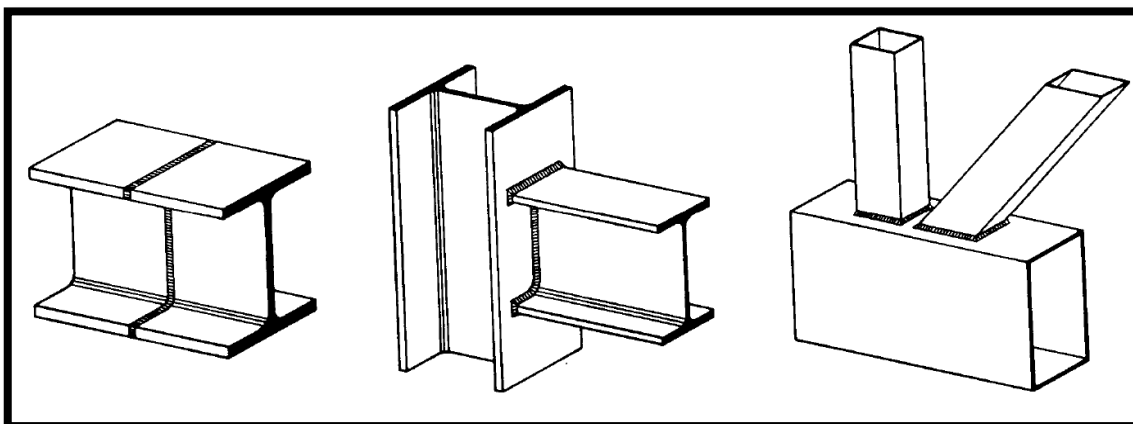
Exemplos de ligações soldadas [23]
